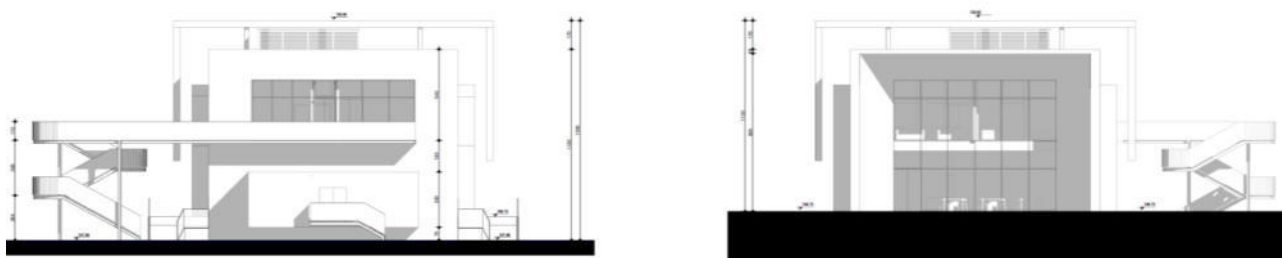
Prospetto sud-est e nord-ovest.
